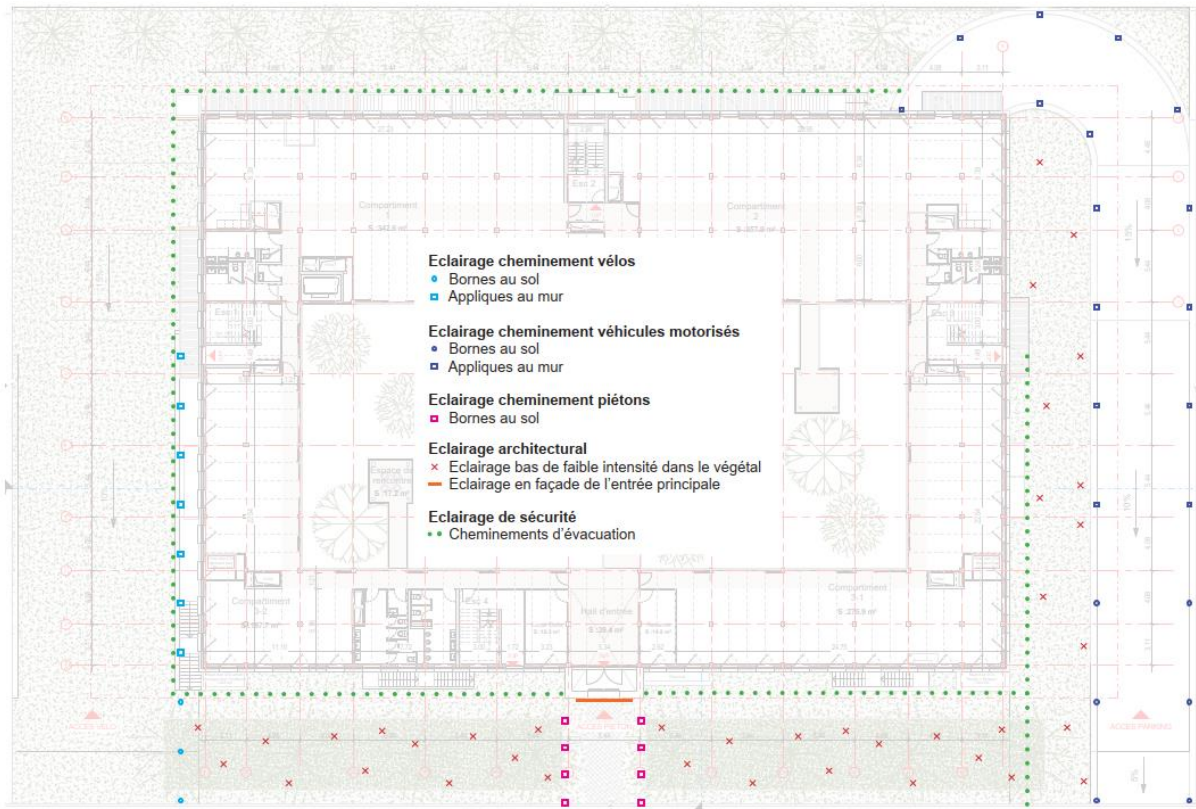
Principe d'éclairage extérieur - PLAN RDC 1* (Maison Edouard François 01/2023). Größere Darstellung in Anhang 06.
